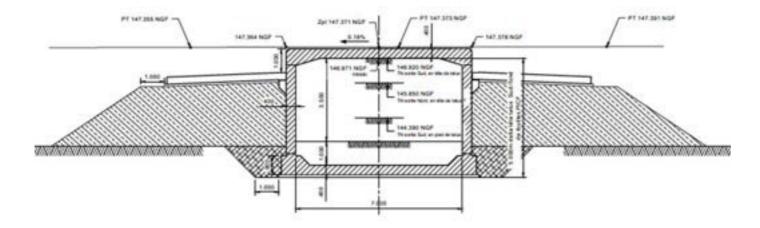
COUPE TRANSVERSALE DU PGF (SOURCE : EGIS,2021)
